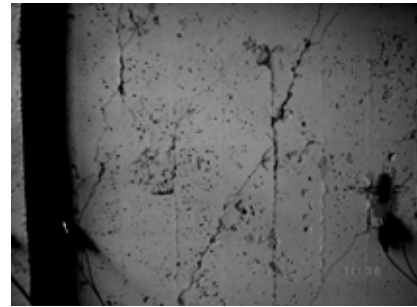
ひび割れ性状 (Fc7W-2)
